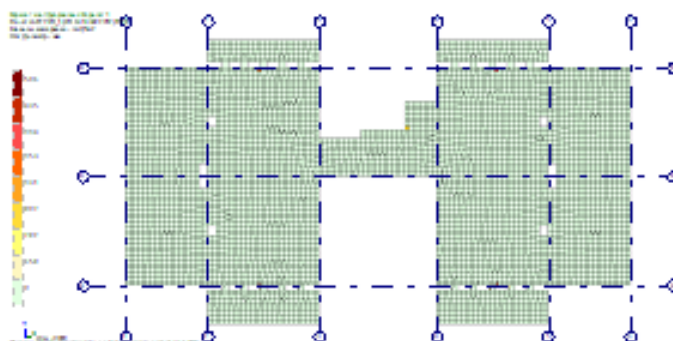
Площадь поперечной арматуры на 1м² перекрытия на отм. 0.000
